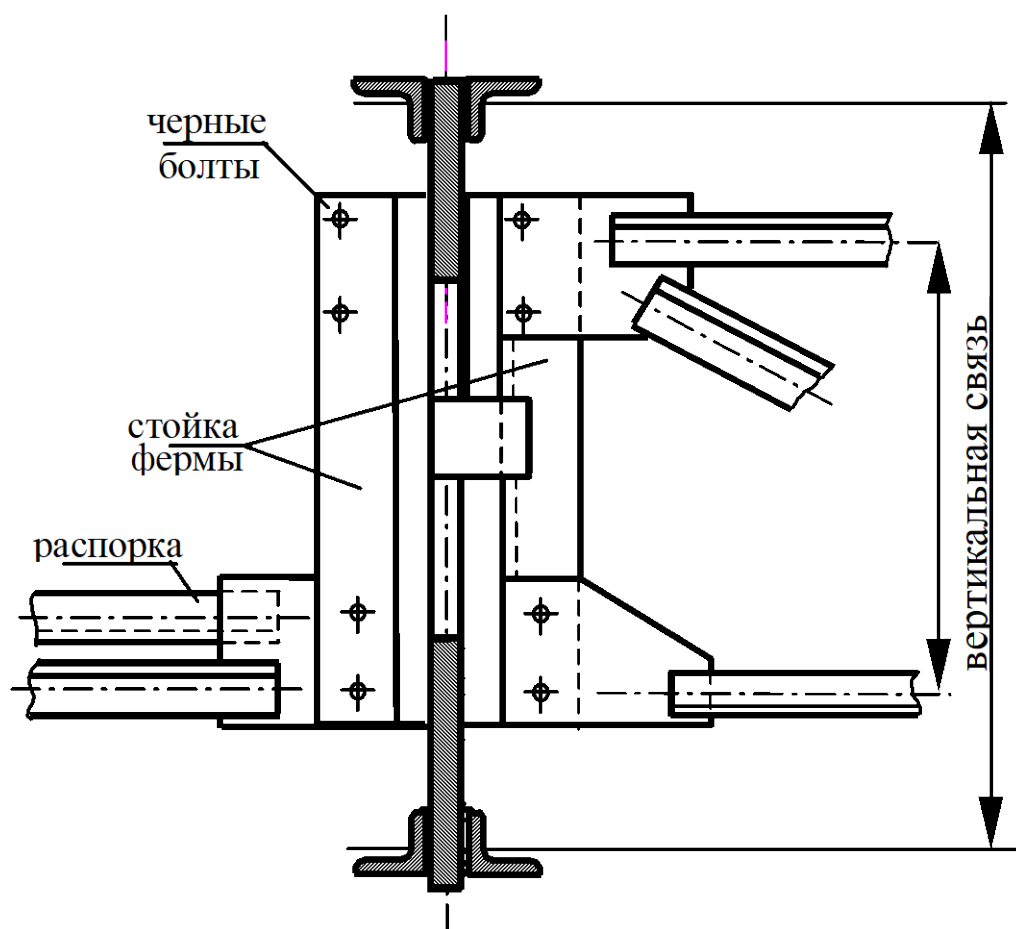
Пример узлов крепления вертикальной связи и распорки к стойке фермы.
